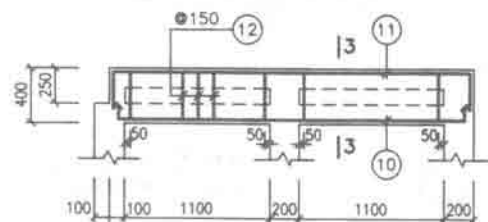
号, 9b号钢筋混凝土化粪池 现浇盖板配筋图 (一)	图 集 号	91SB4-1
